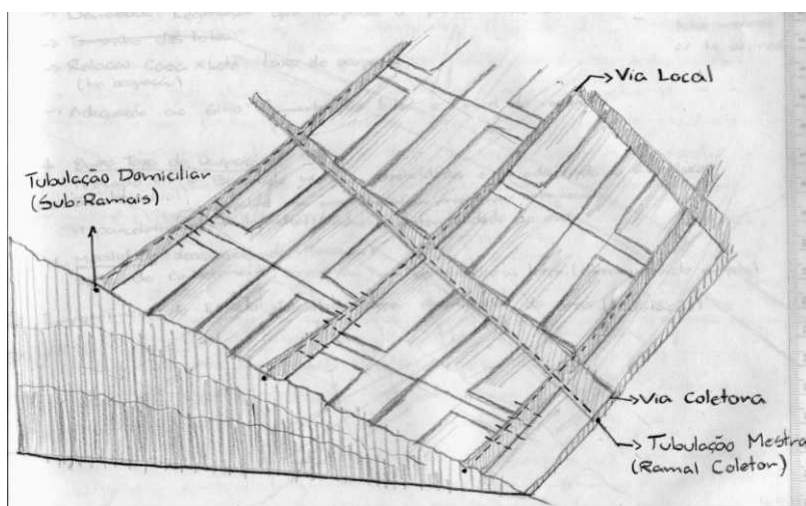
Esquema de traçado viário e disposição de lotes para situação de elevada declividade. Elaborado por Marlon Pscheidt, 2006.
